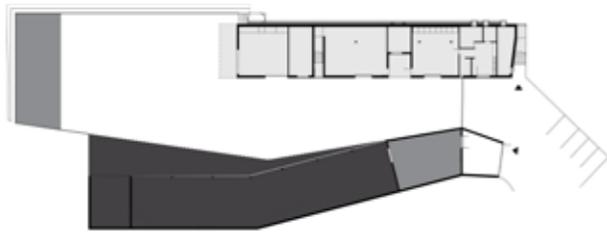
Forstwerkhof Biel - CH / Grundriss
